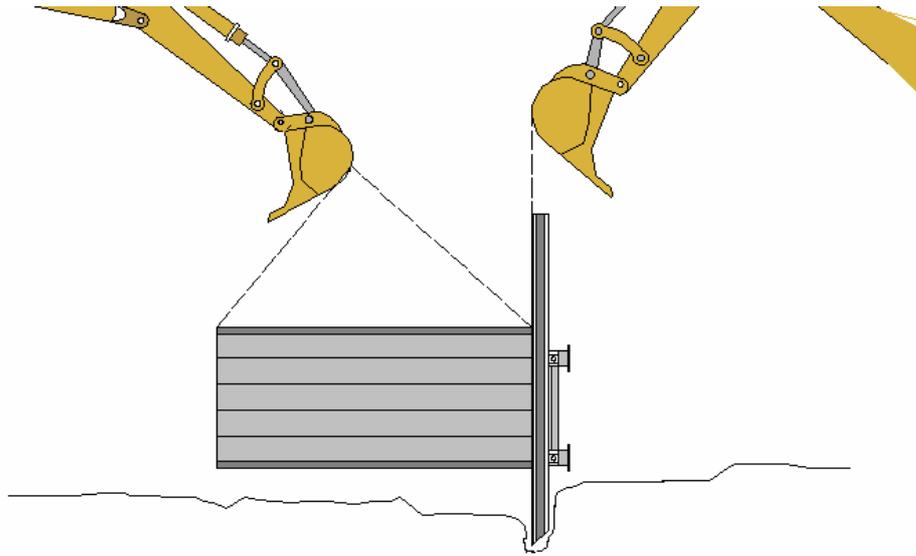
Colocación del primer módulo del Sistema de Guías Deslizantes con la utilización eventual de dos excavadoras./Elaboración Propia.
